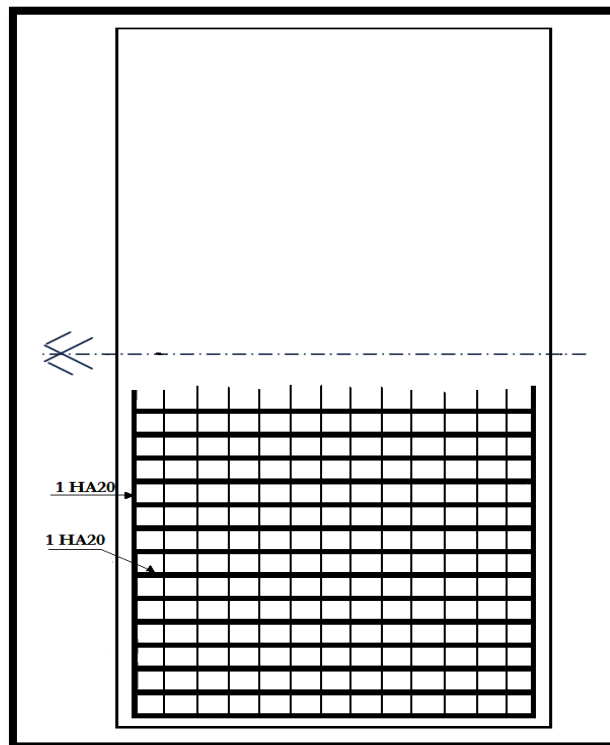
Ferrailage de la semelle (nappe supérieure).
